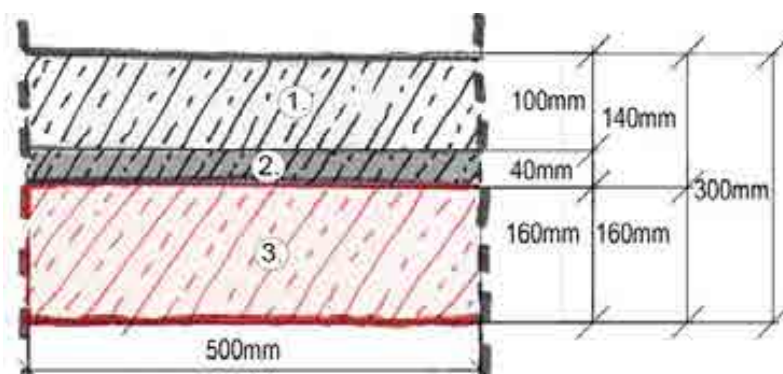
Durchschnittliche Betonmenge, = 140mm Beton Bestand und 160mm Beton Neu, die kann als Vorlage gestellt werden, Hohlraumdecke Bestand und Neu \_30cm\_10cm
